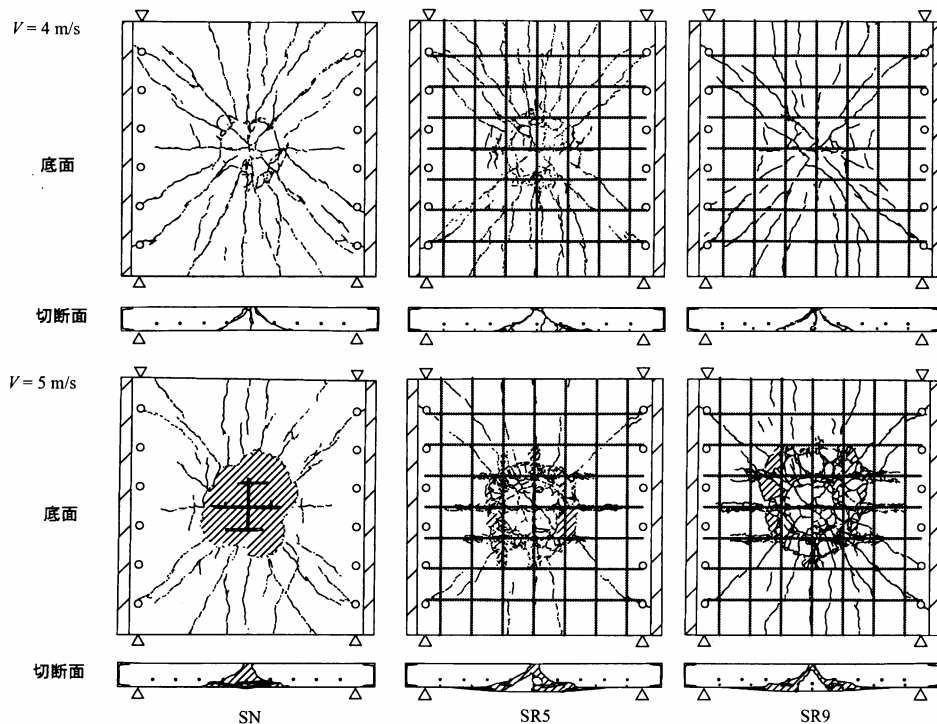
RC 版のひび割れ性状(単一衝撃载荷)
